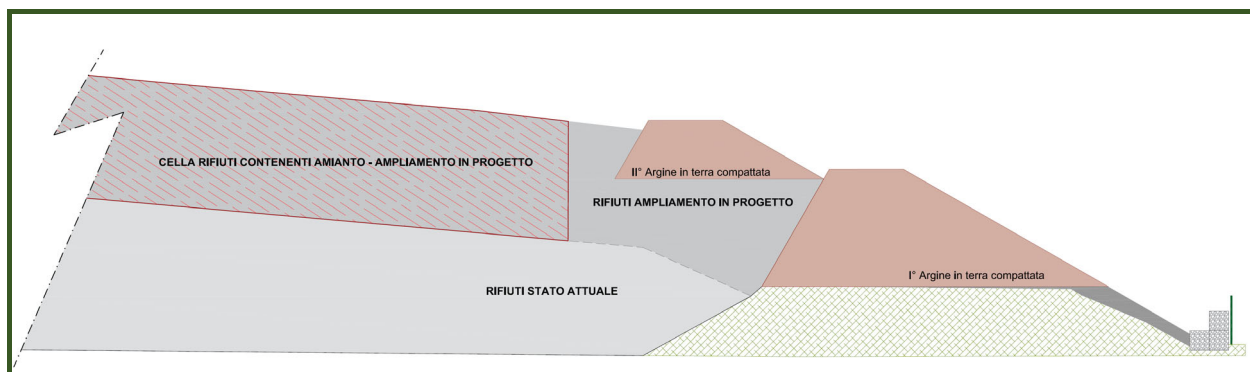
/II: Schema ubicazione cella amianto rispetto ad argini perimetrale
